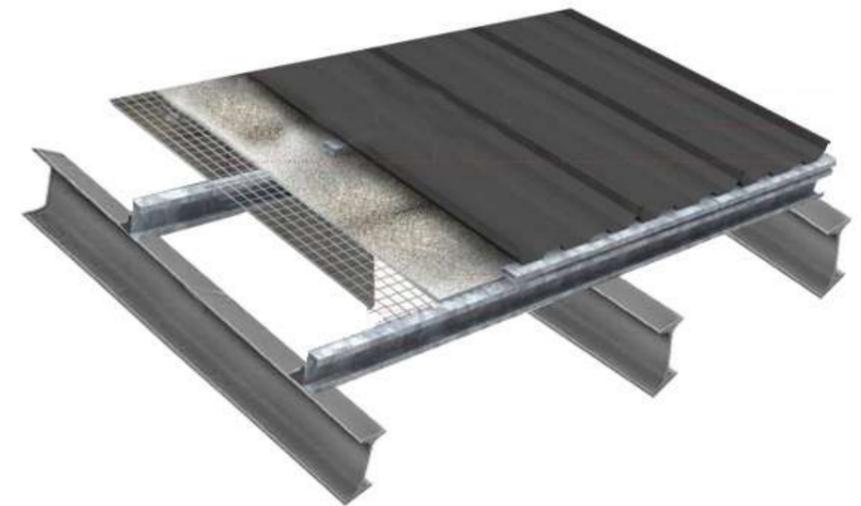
IMAGEN REFERENCIA. Estructura de cubierta liviana metálica
